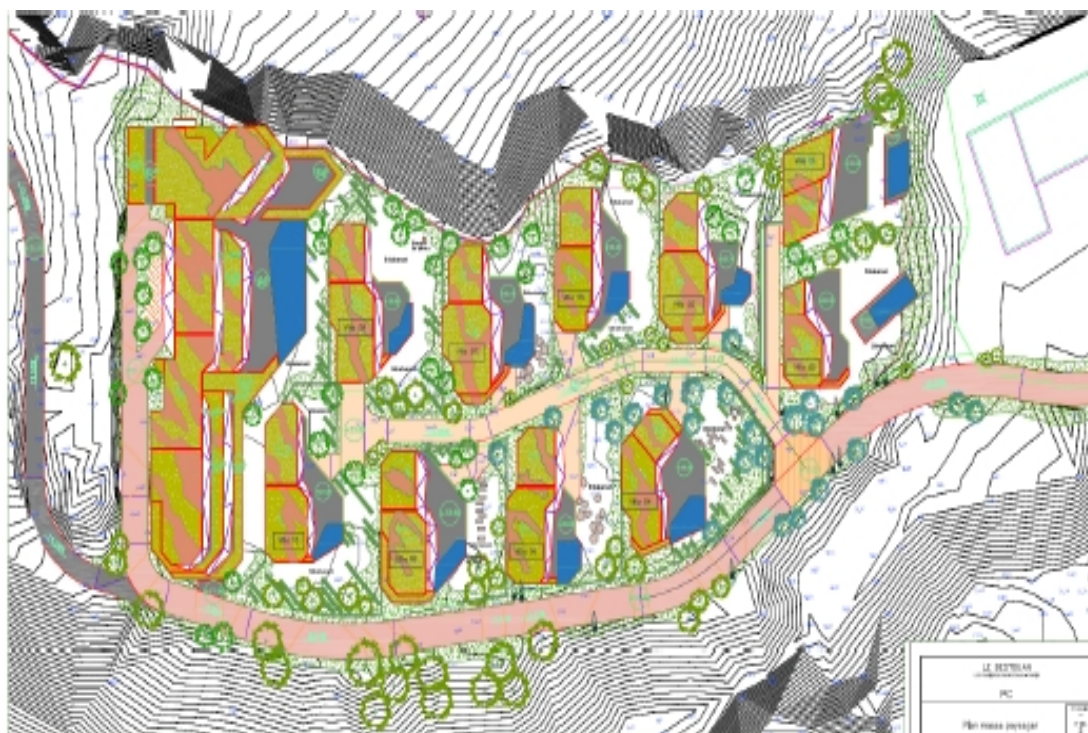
plan masse du complexe hôtelier- Source : étude d'impact
